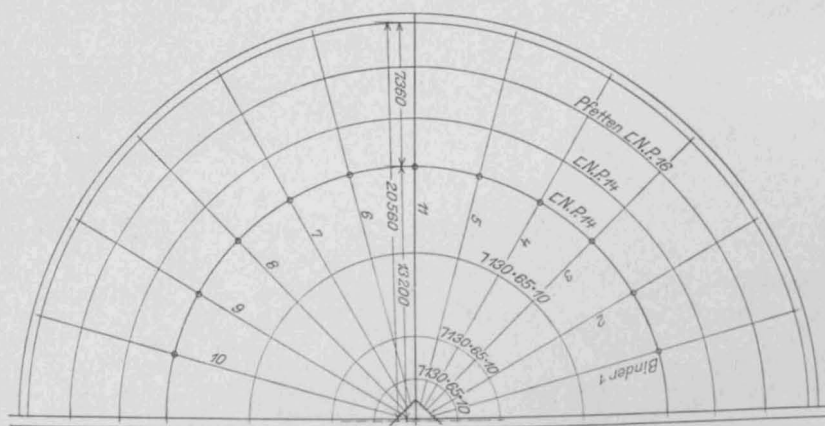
Grundriß des Daches über dem Kassenraum.
